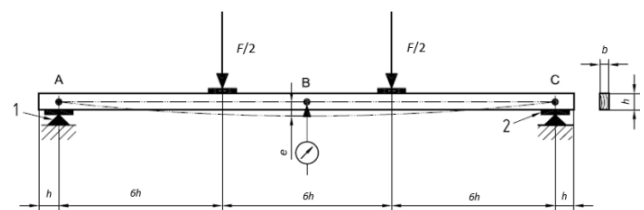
Ensaio de flexão de peças estruturais. Fonte: Autor (2022)
